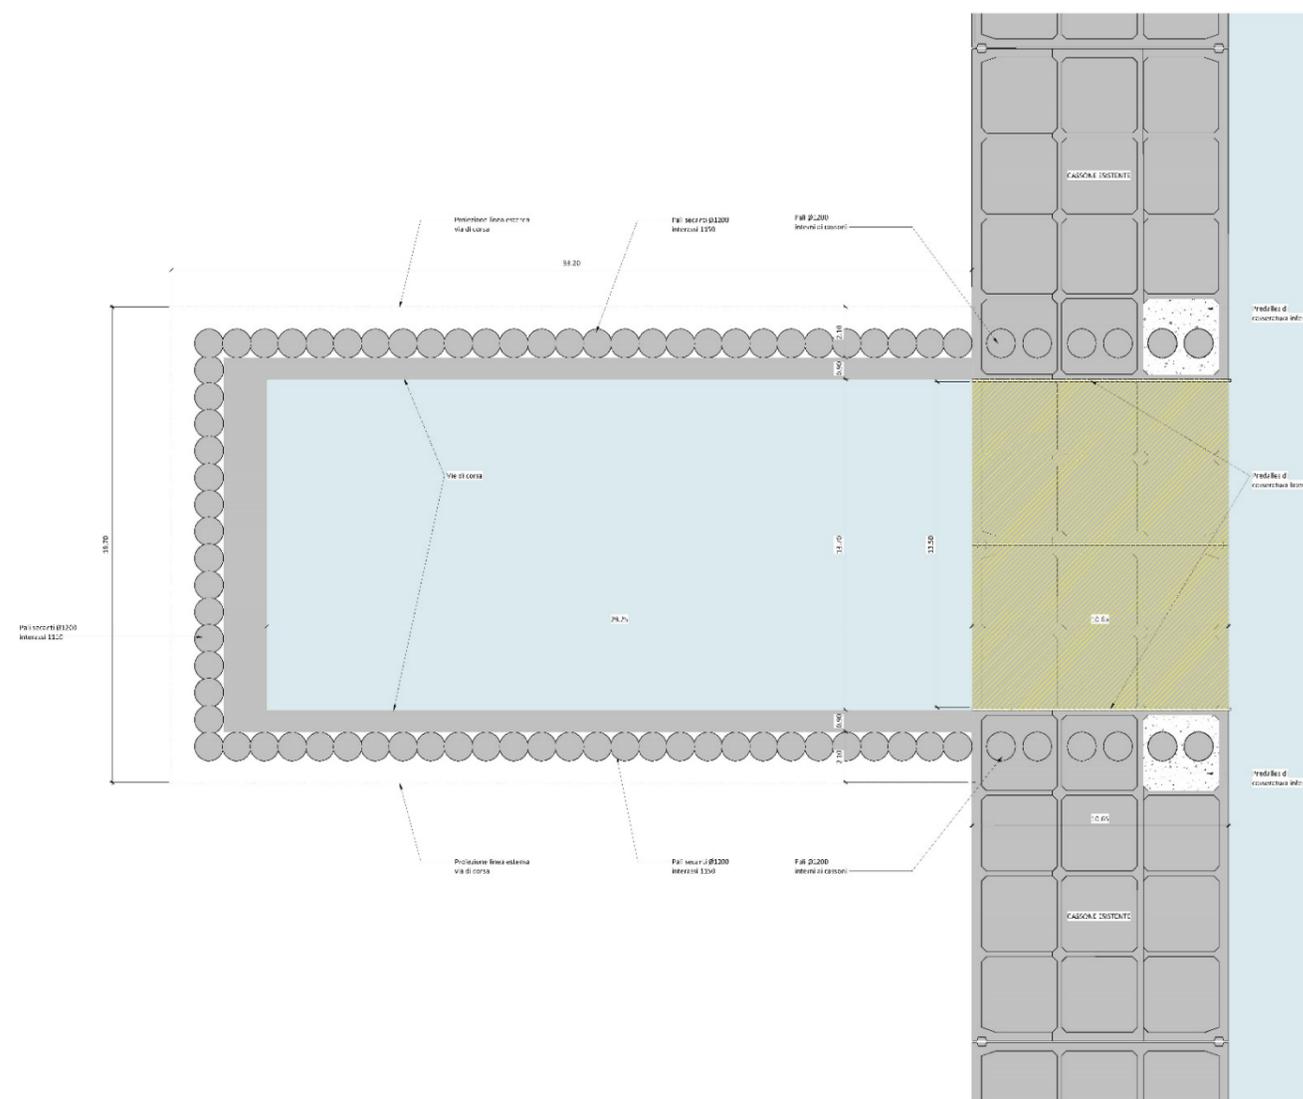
Pianta vasca travel quota +1.20 (in giallo evidenziata l'area cassoni da demolire)
